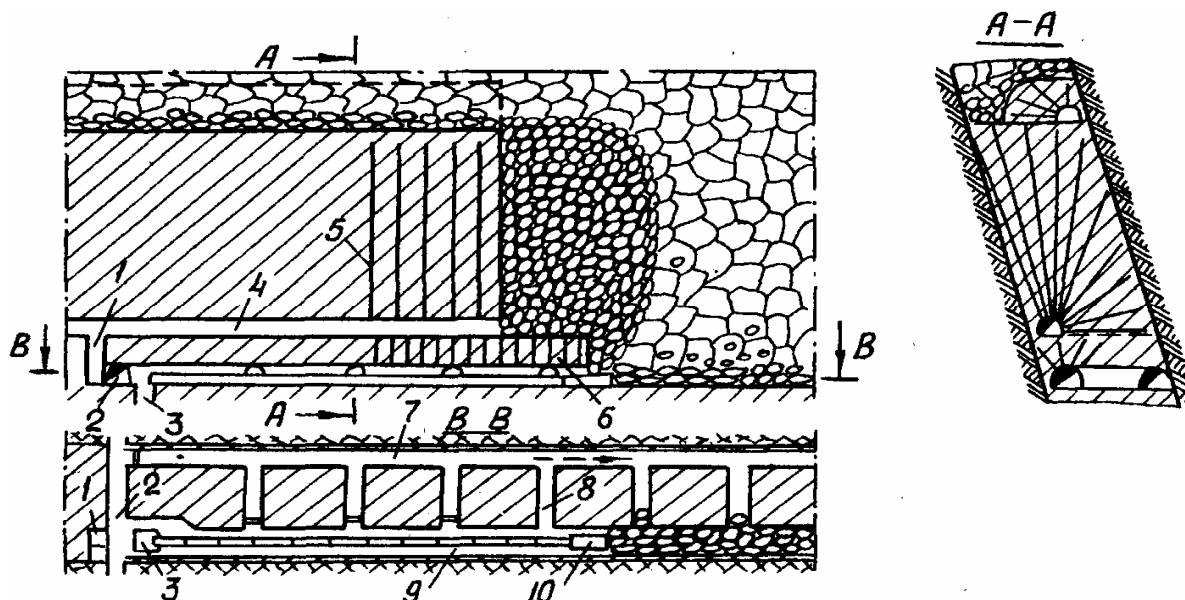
Система разработки с этажным принудительным обрушением с торцевым выпуском руды: 1 – ходок; 2 – орт; 3 – рудоспуск; 4 – буровой штрек; 5 – скважины для отбойки руды; 6 – предохранительный козырек; 7 – вентиляционный штрек; 8 – вентиляционные сбойки; 9 – виброконвейер; 10 – вибропитатель
